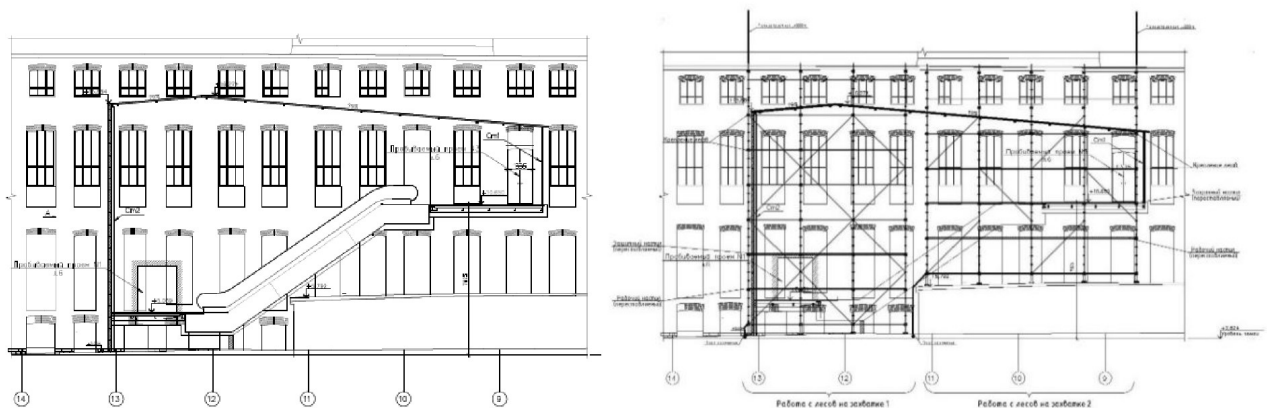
Ескалаторний хол. Загальний вигляд і схема установки риштування
